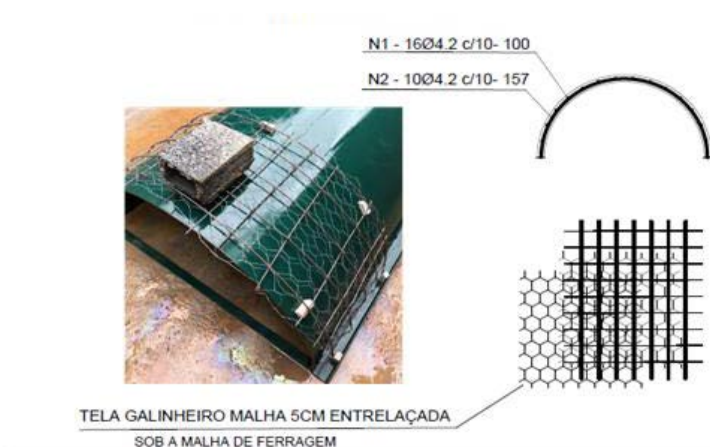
Detalhes da armadura difusa dos painéis de argamassa para a câmara de digestão dos TEvap.
